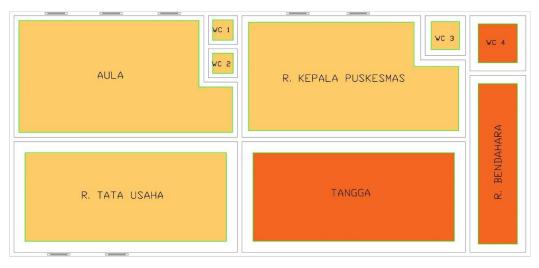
8 Denah Gedung Rawat Inap L. 2
